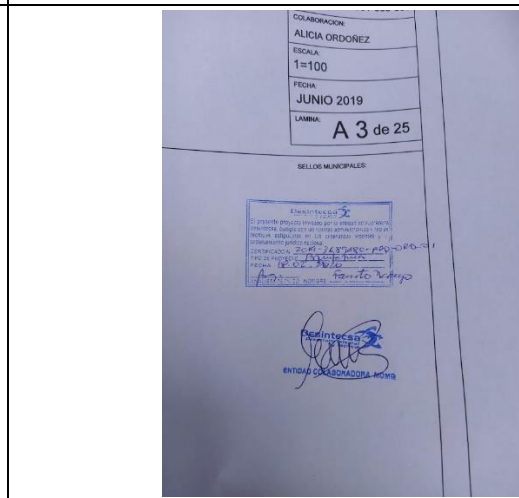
Vista de planos 2019-3689480-ARQ-ORD-01. Certificados.
